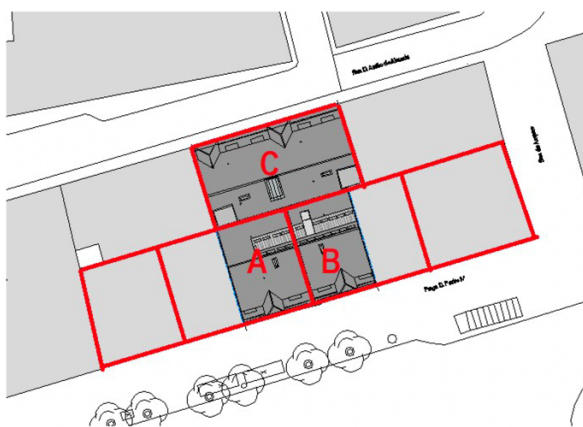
Zonas A e B com fachada para a Praça D. Pedro IV. Zona C com fachada para a Rua D. Antão de Almada.
